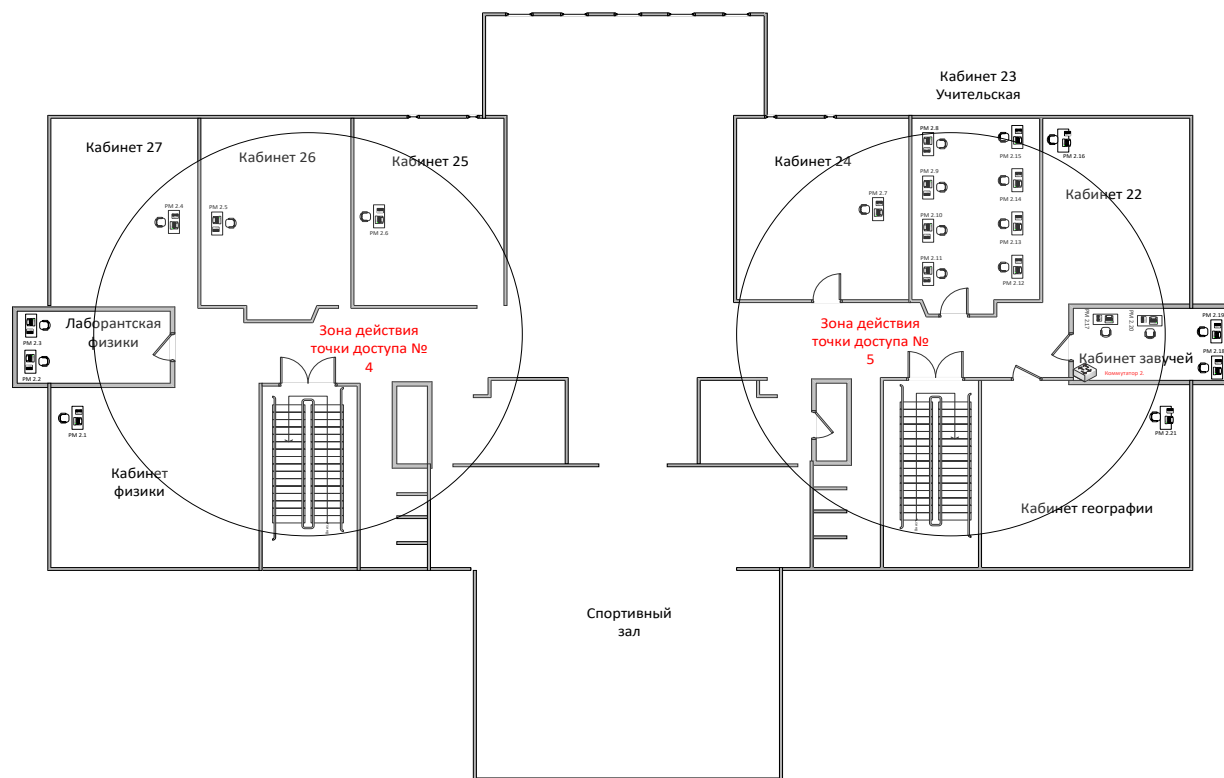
Схема размещения элементов сети на плане 2 этажа
